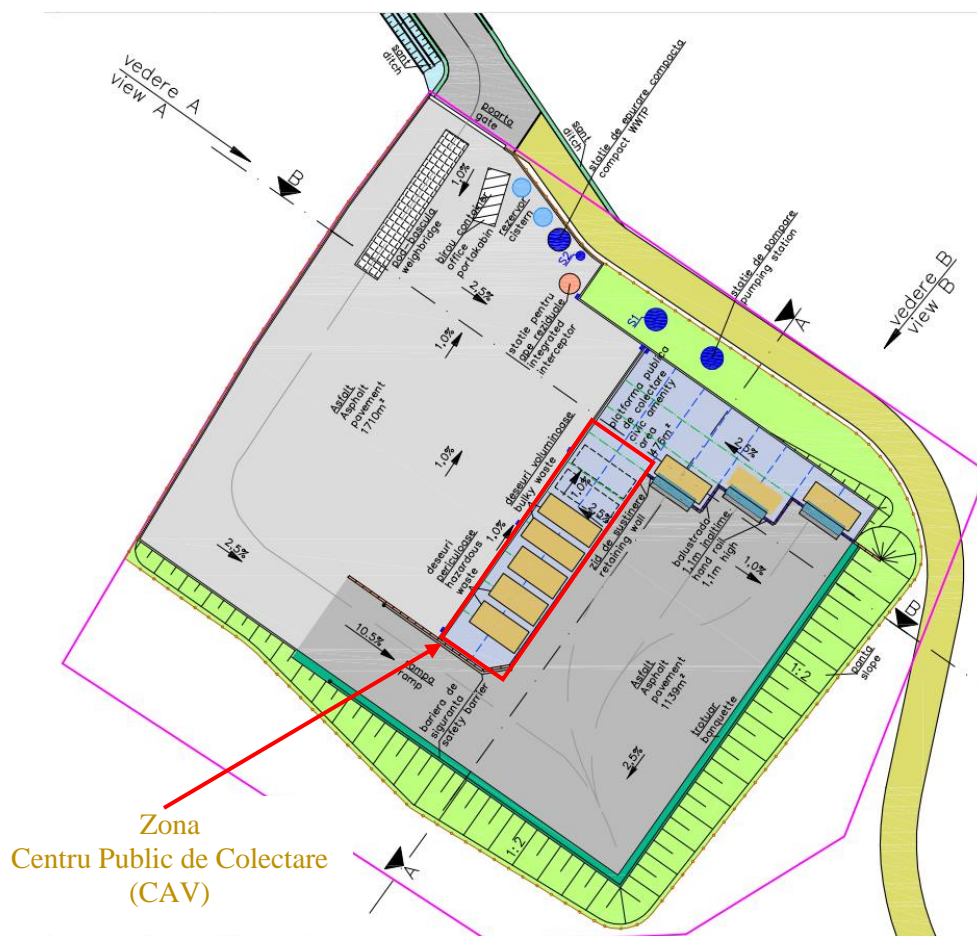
Plan de situație ST Câmpulung Moldovenesc
